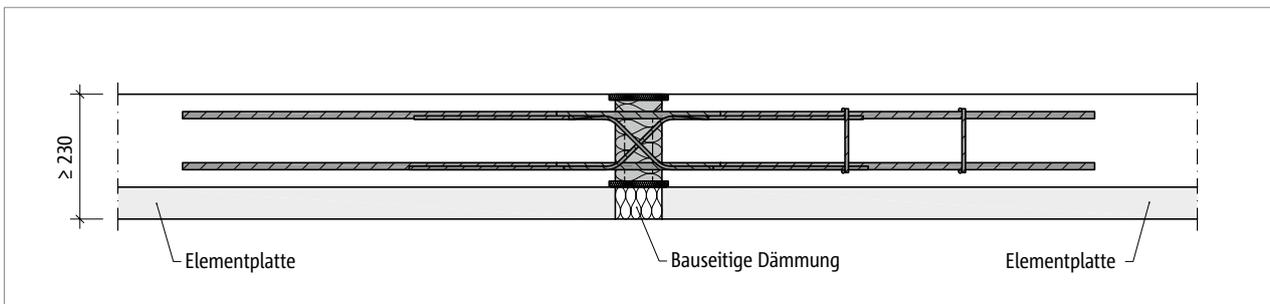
Schöck Isokorb® T Typ DP: Elementdecke mit aufgesetztem Isokorb® T Typ DP
